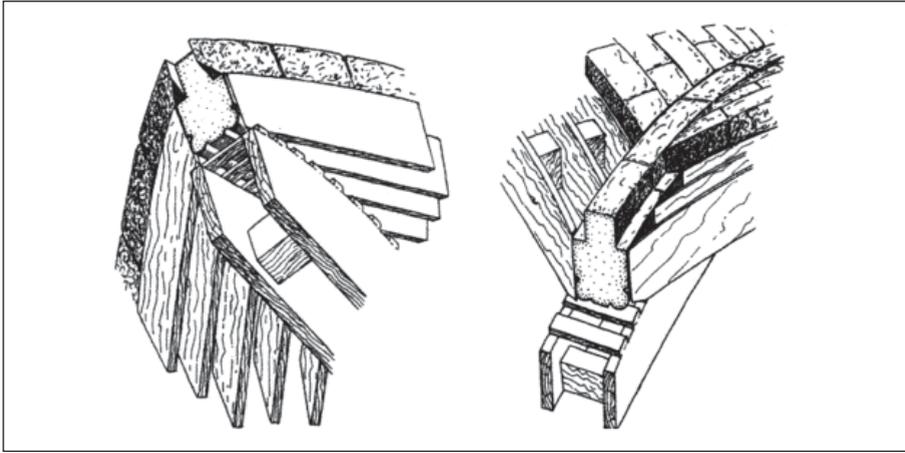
Detalle de la cimbra. Apeo de la plementería sobre los nervios; vista inferior y vista superior (Fitchen, 1961).
